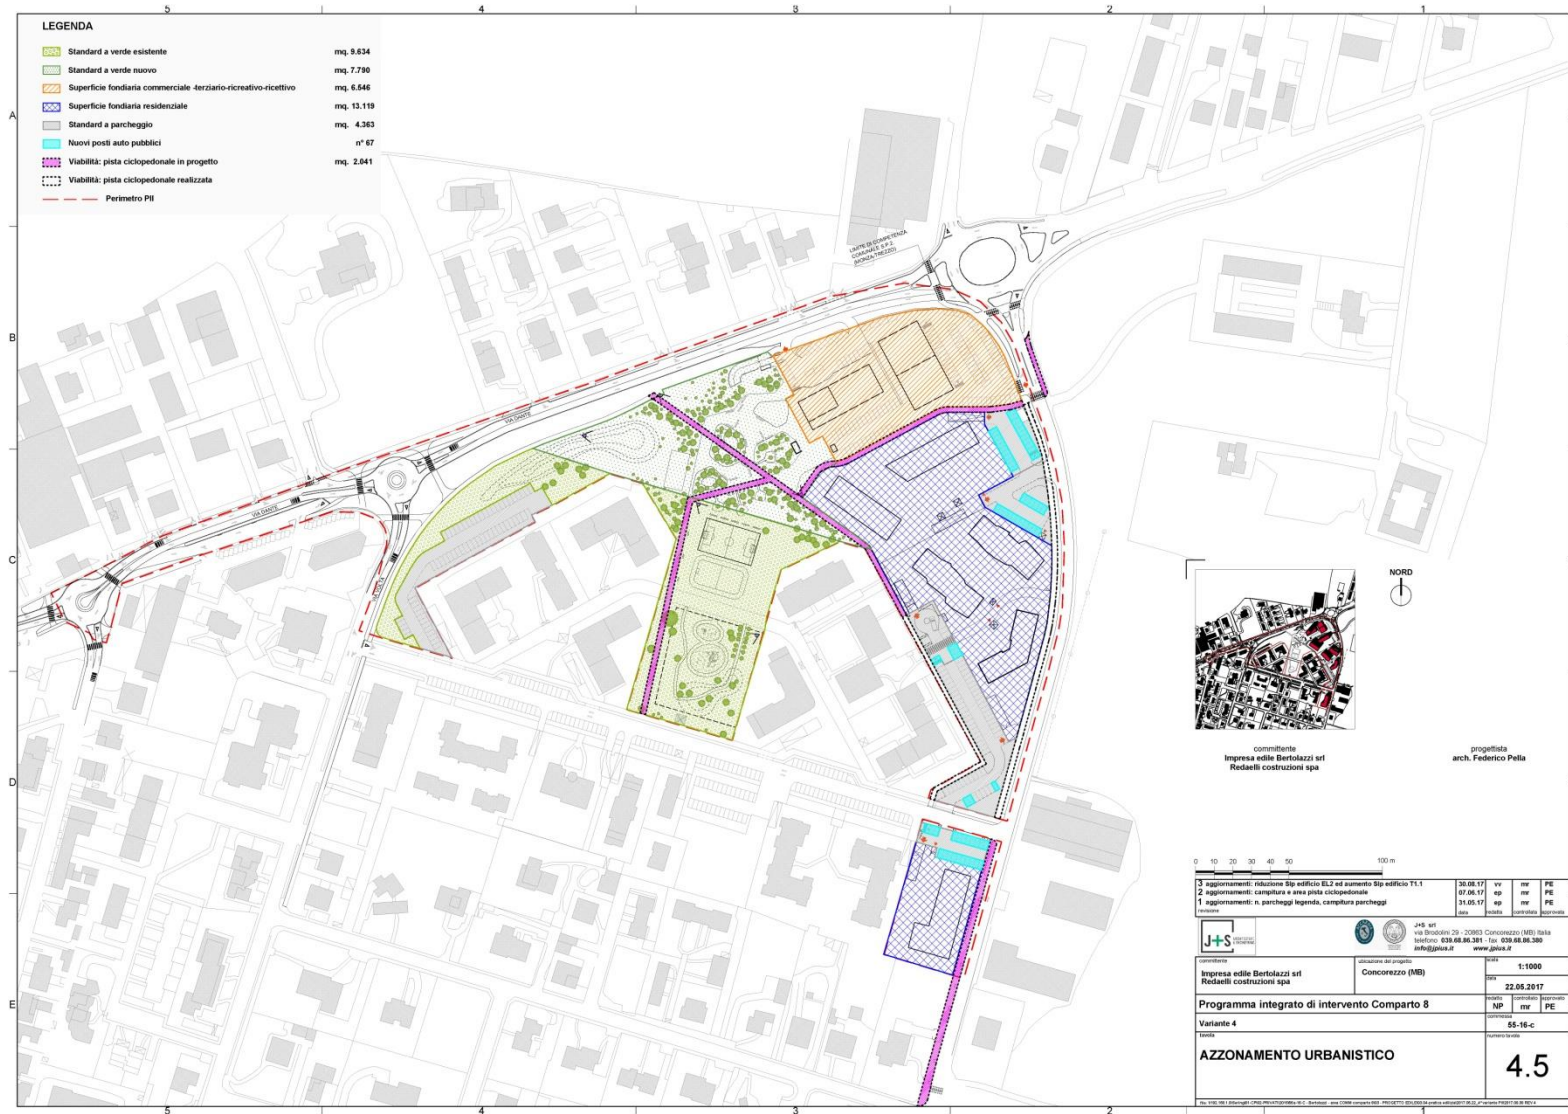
Tavola 4.5 – Variante 4 alla convenzione di PII
